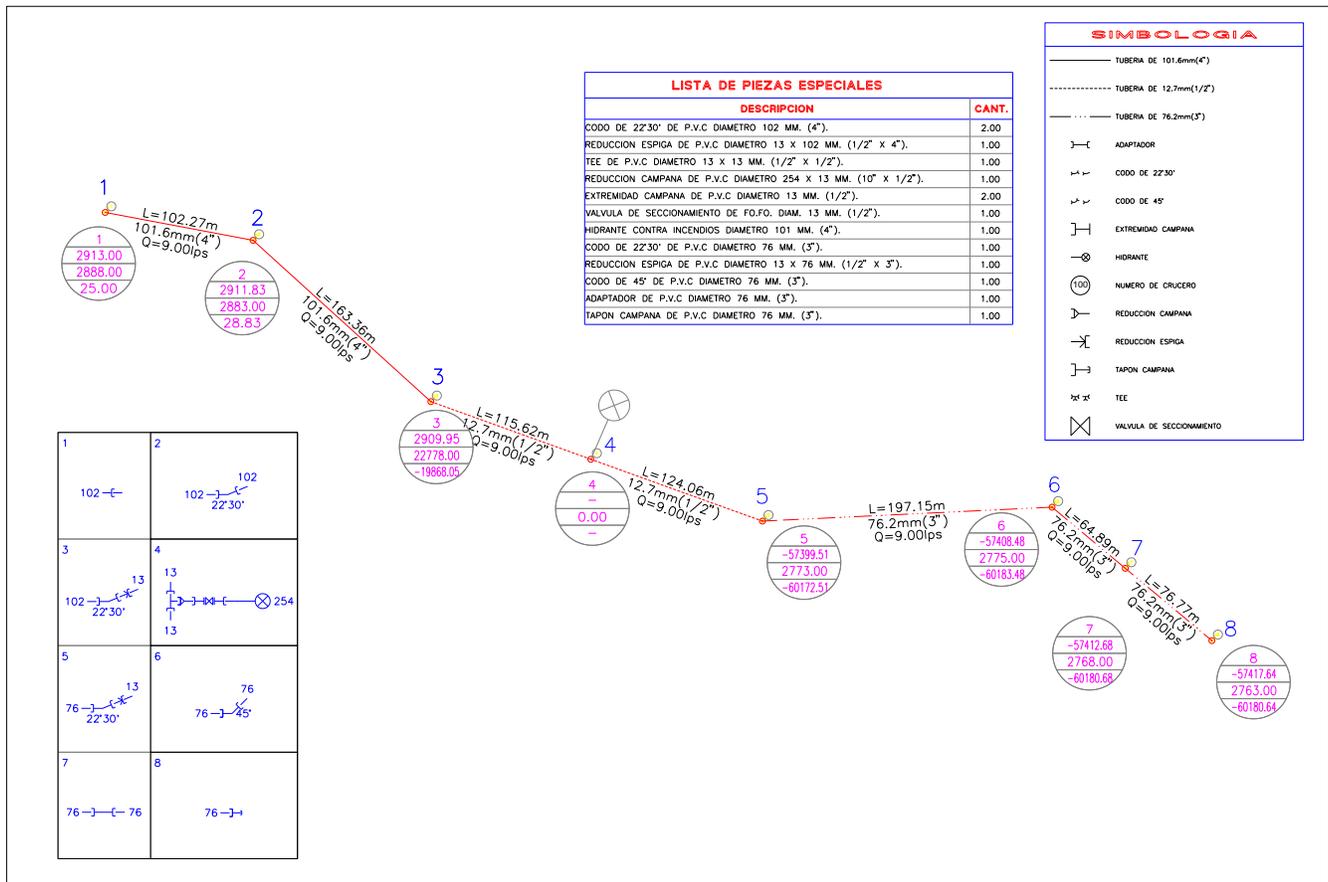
Plano de línea de conducción generado con AutoCad y CivilCad.
